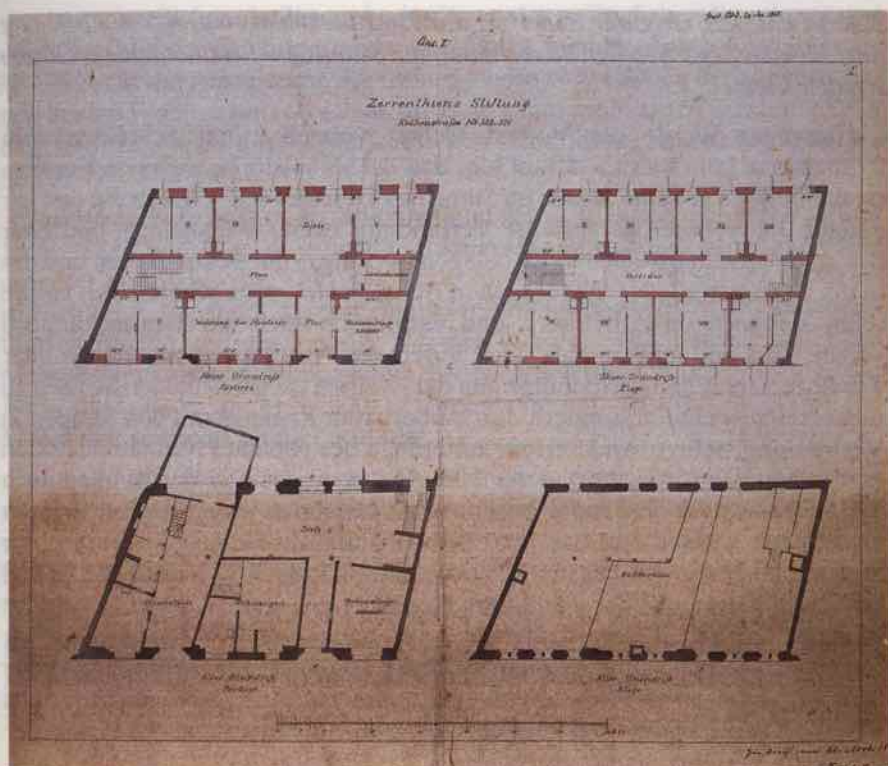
Bauzeichnung von 1865. Grundrisse.
